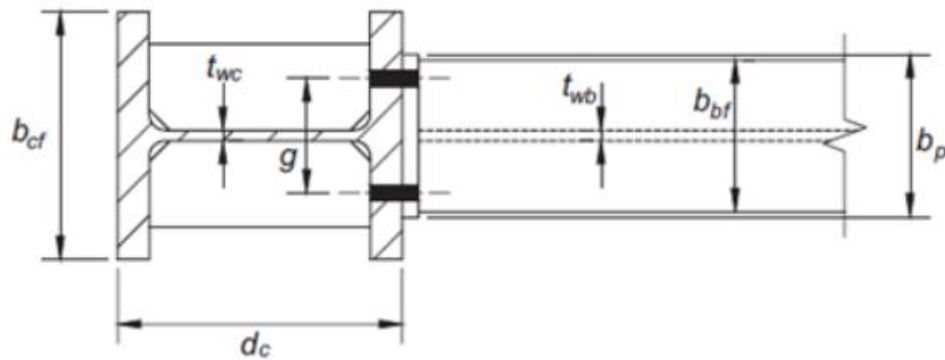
Conexión tipo placa final sin rigidizar (4E) Vista lateral
